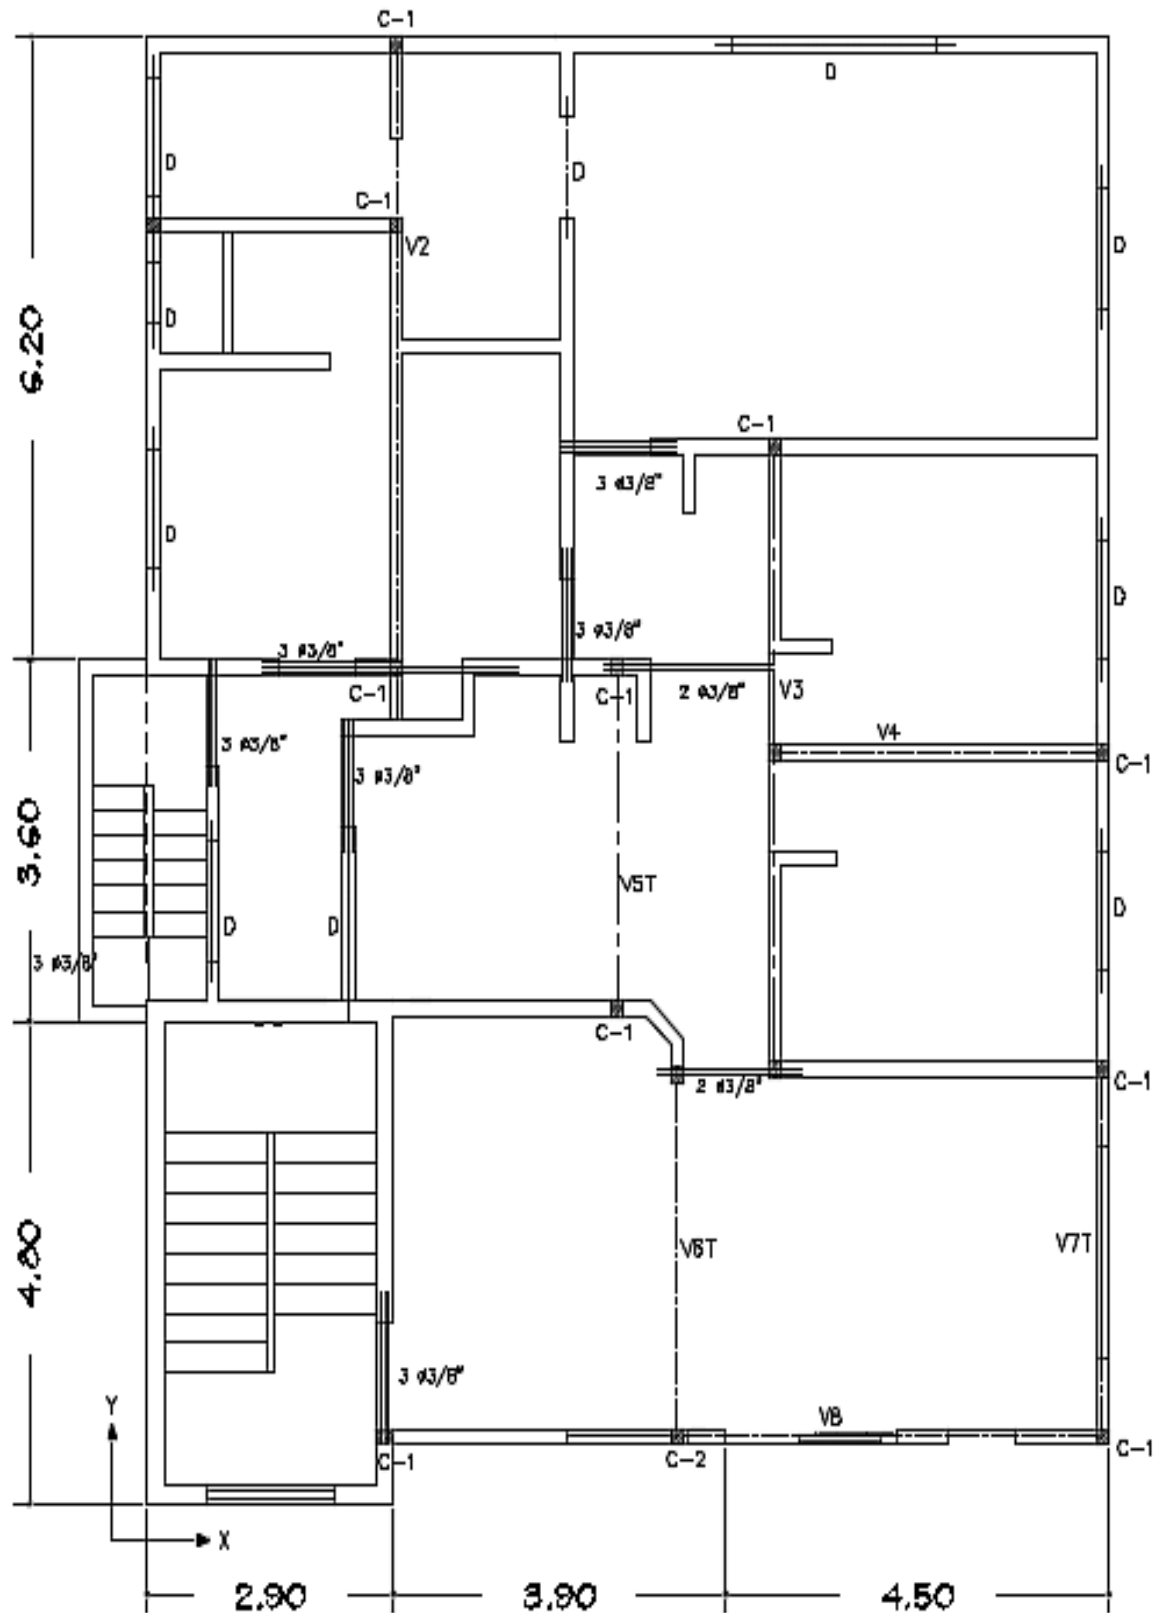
Vista con las dimensiones en planta en la que se distinguen los elementos estructurales.
